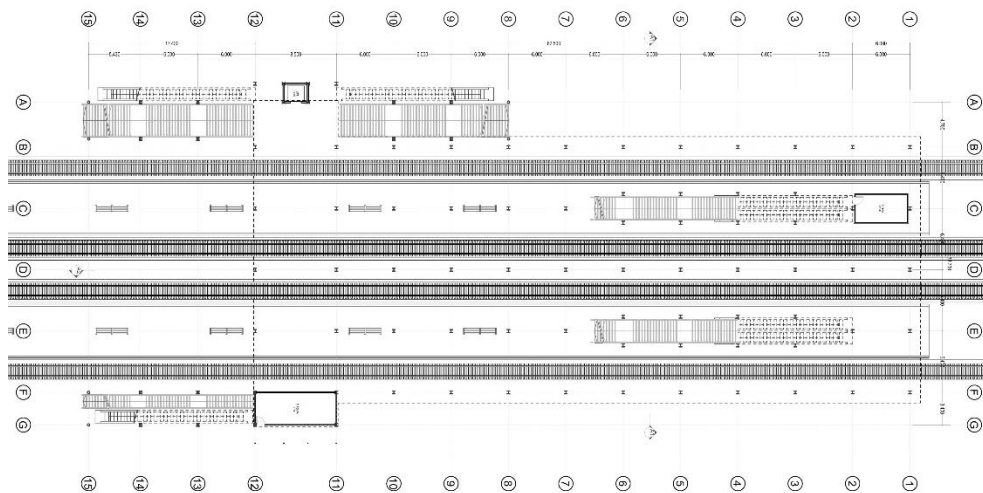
Siteplan Rancangan Stasiun Sentolo
